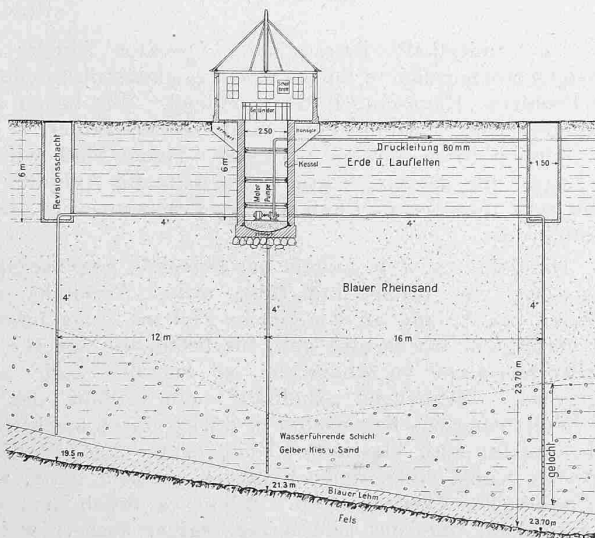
(link-) Schnitt. — Masstab 1 : 400. — Abb. 2. Grundriss.
